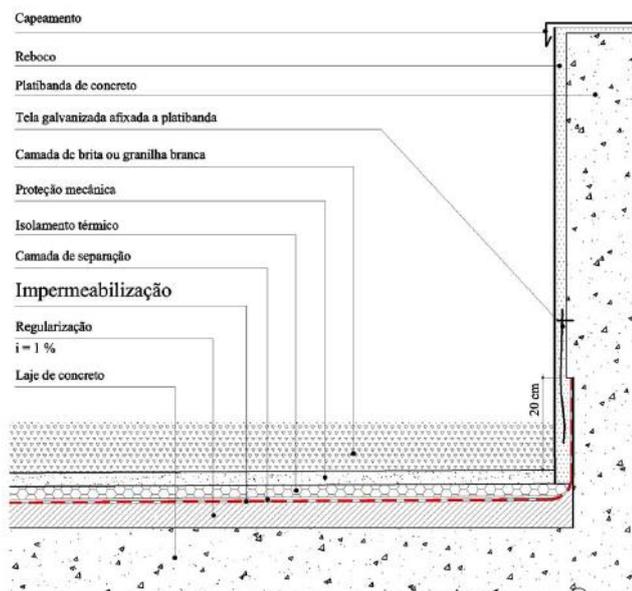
Detalhe de ancoragem da impermeabilização com tela metálica. Fonte: CRUZ (2003)
